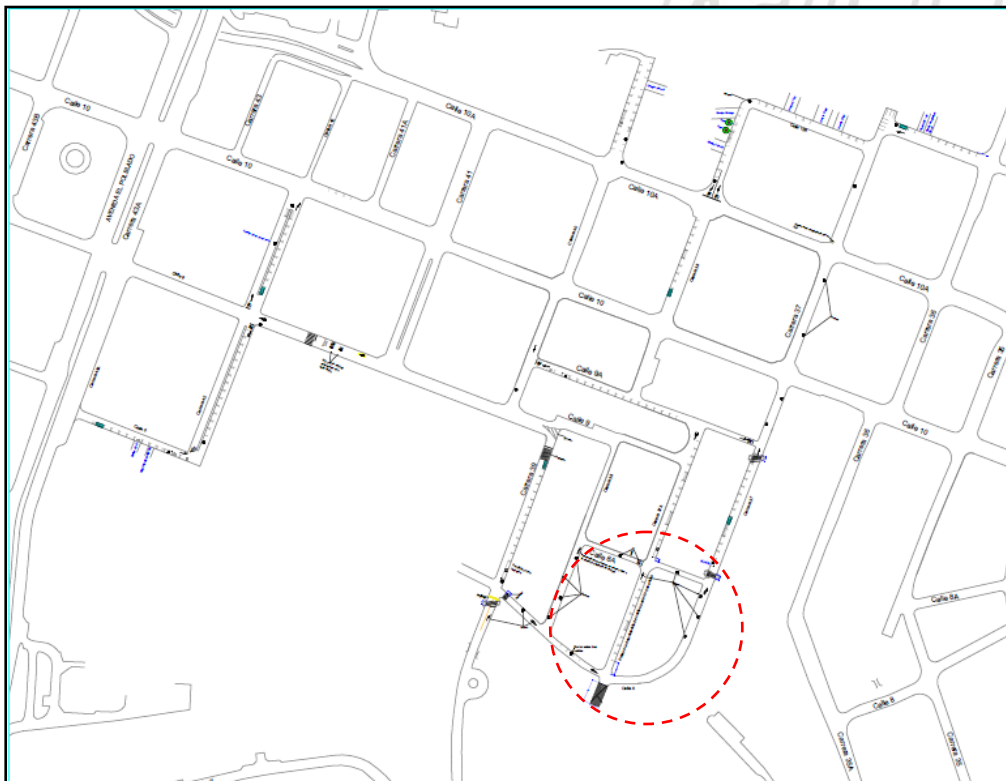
Plano final en AutoCAD - Z.E.R Poblado
